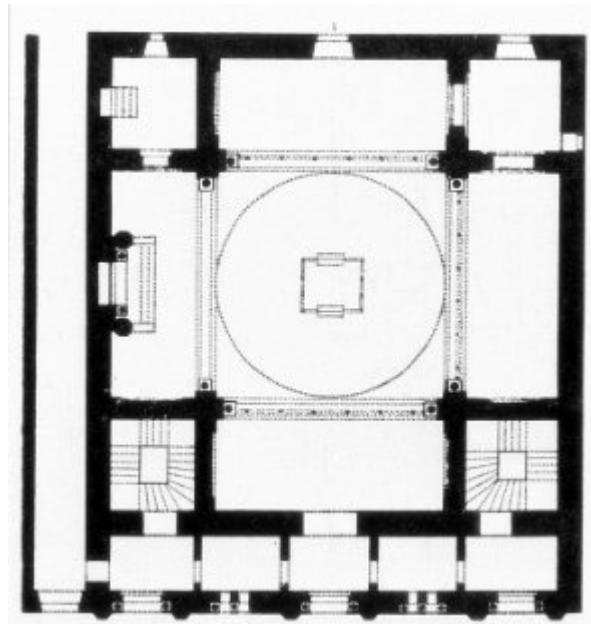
Grundriss Synagoge Köln
